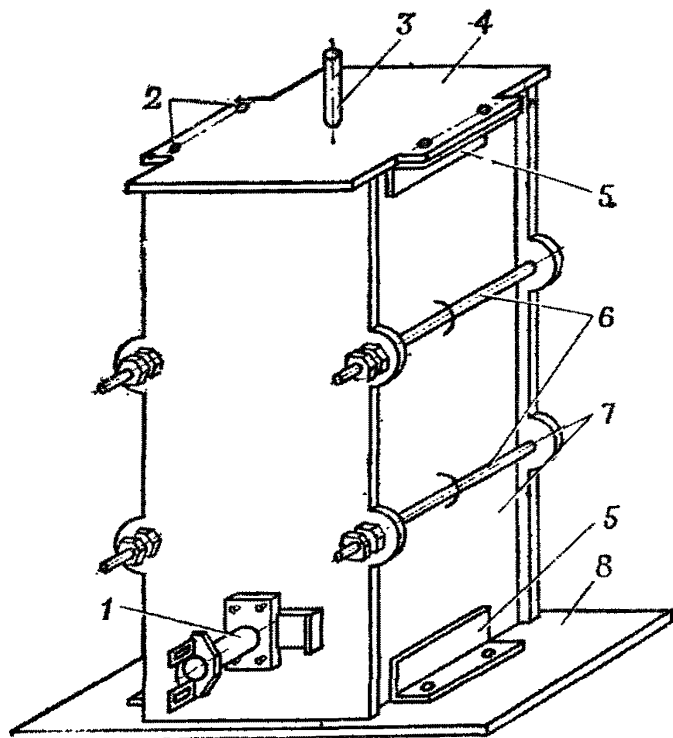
Общий вид формы для изготовления образцов-кубов вибронанетательным способом бетонирования:
